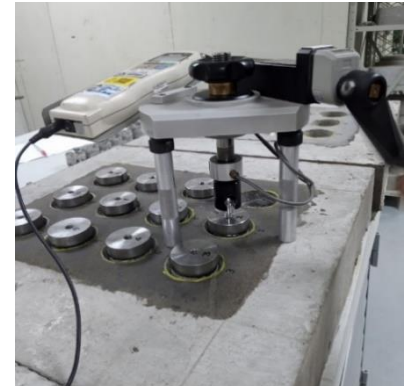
Colagem das placas metálicas redondas para o ensaio de aderência a tração.
